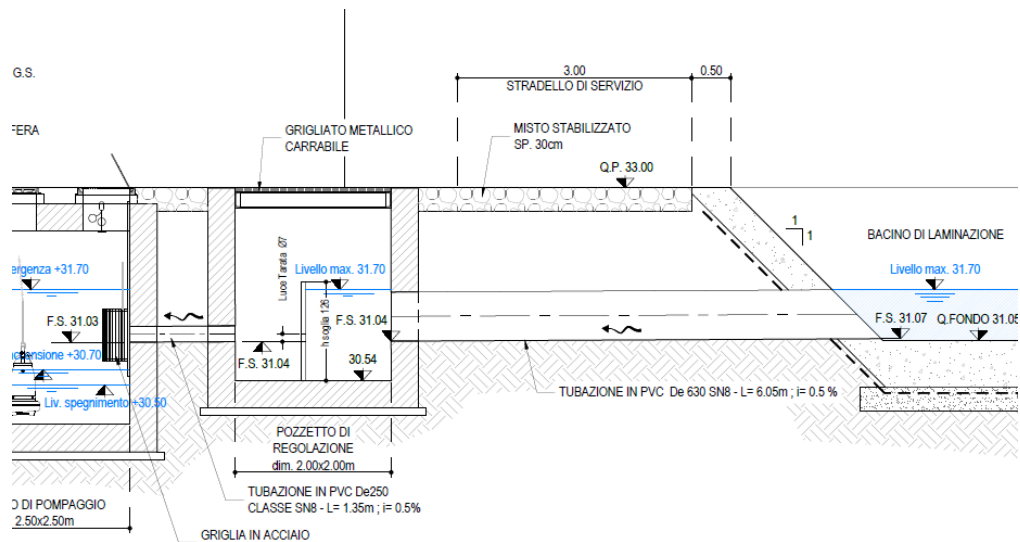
Sezione di scarico dal bacino di laminazione con pozzetto di regolazione delle portate e impianto di sollevamento
